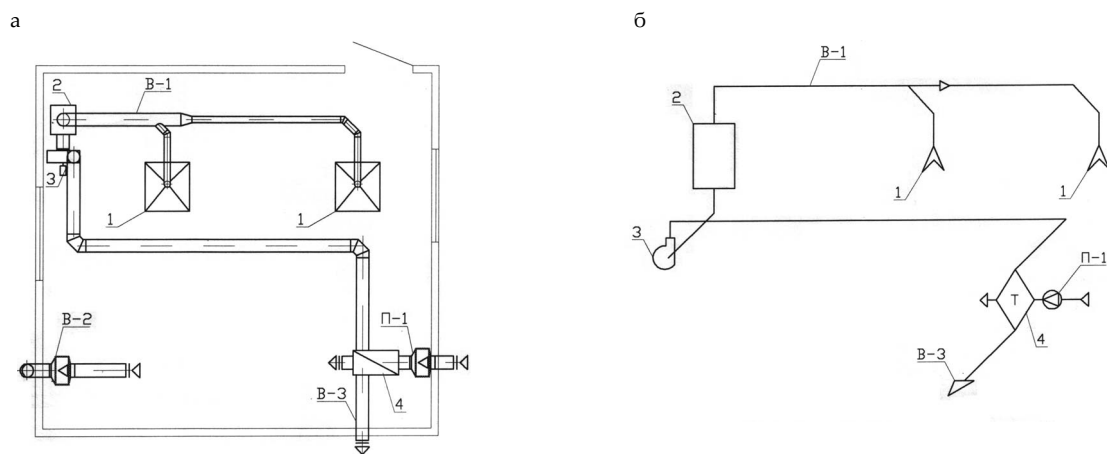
Второй вариант размещения аэрозолеуловителя в системе вентиляции:
